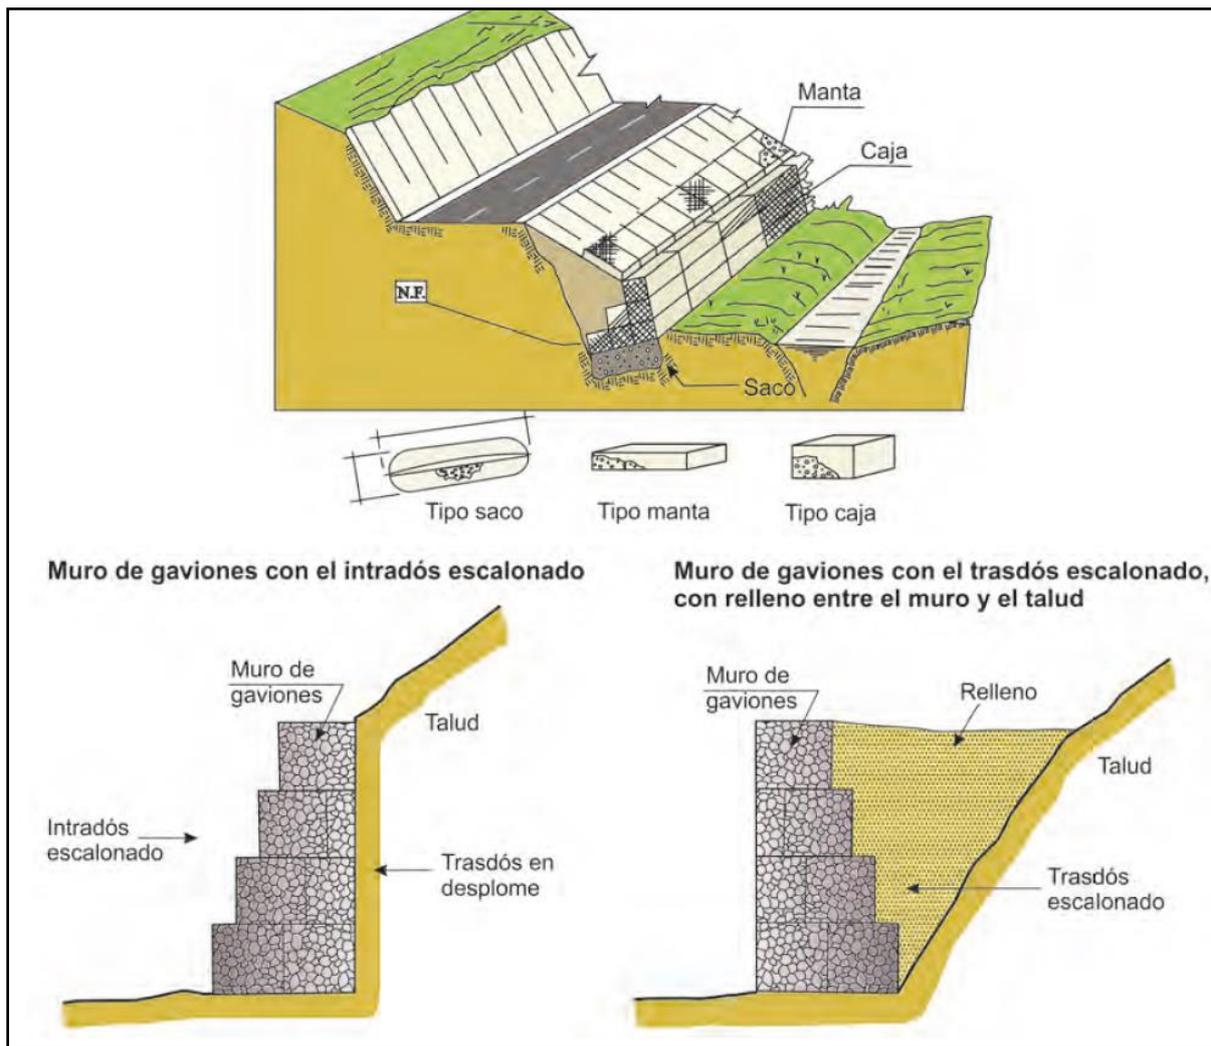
Muro de gaviones y ejemplos de aplicación, (Vilchez, 2021)
